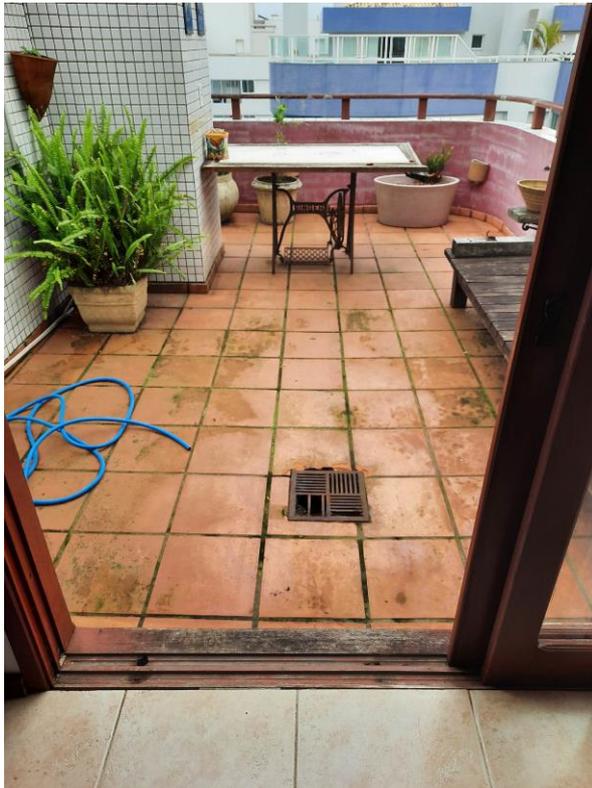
e 06: Vista do terraço lado oeste do apartamento 504. Observar fissuras nos elementos de concreto – platibanda e fechamento do telhado.
